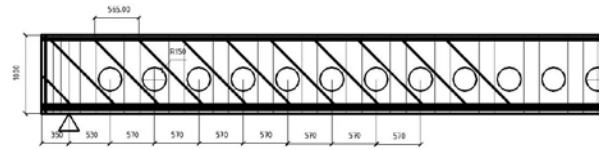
Прогонова будова з поперечними круглими отворами. Розташування арматури. Варіант № 4
